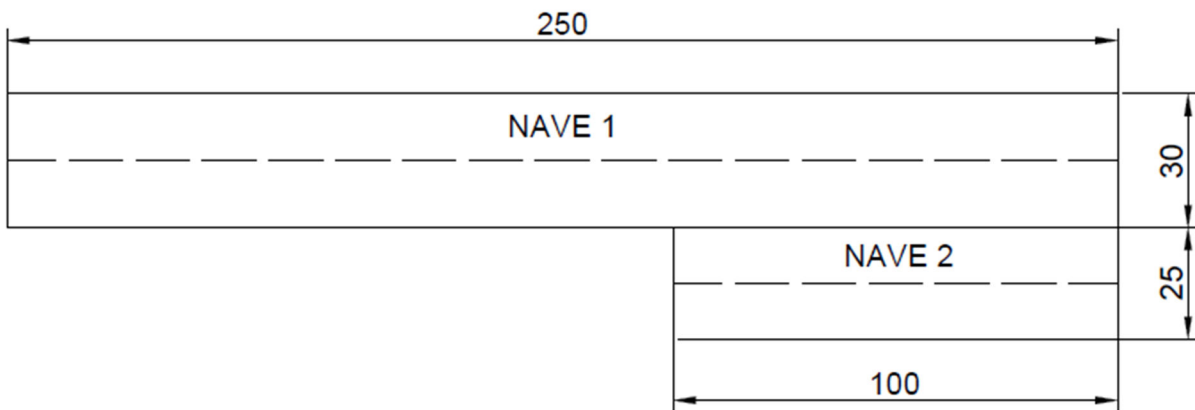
Disposición en planta de las dos naves (cotas en metros).
